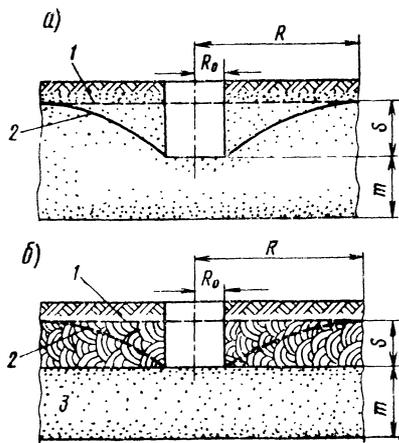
Расчетная схема открытого водоотлива из котлована несовершенного типа:
